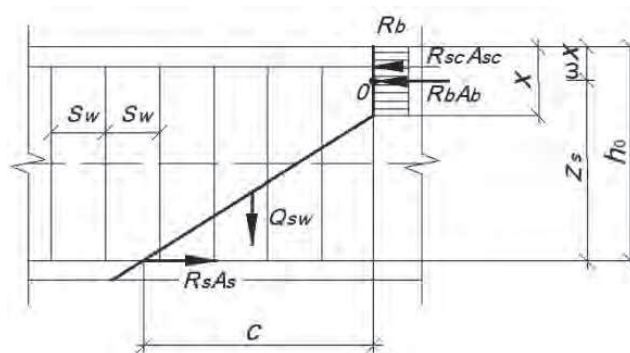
Схема усилий при расчете железобетонных элементов по наклонному сечению на действие моментов
